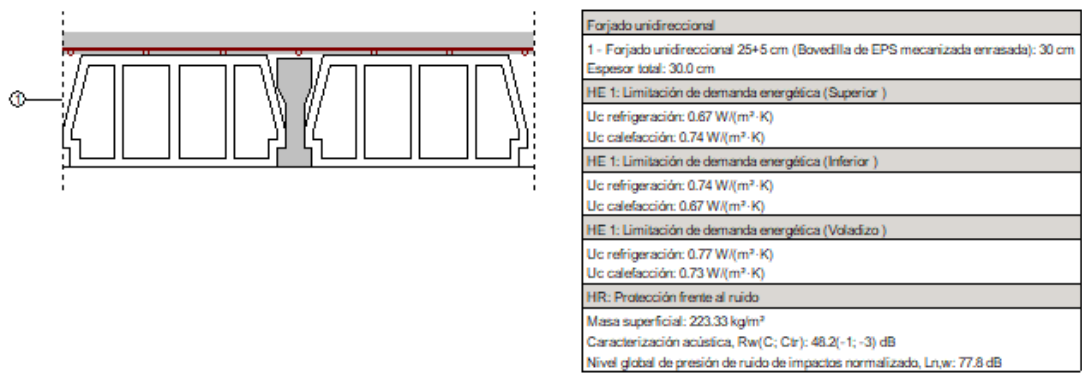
Detalle Cimentación Forjado Unidireccional. Fuente: Programa CypeMEP
